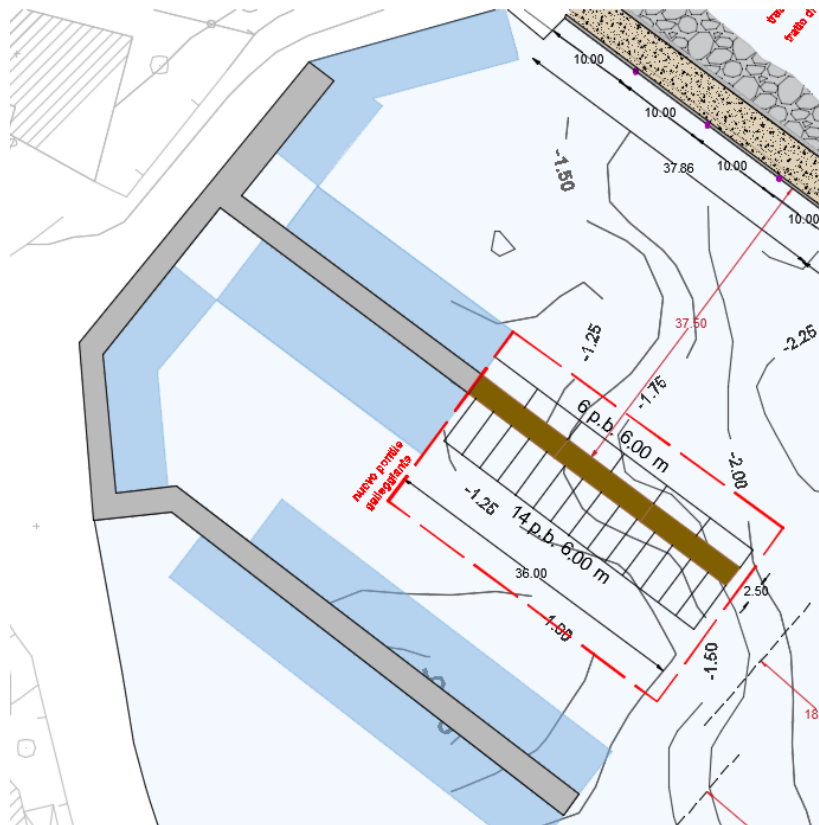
Stralcio planimetrico prolungamento pontile galleggiante
